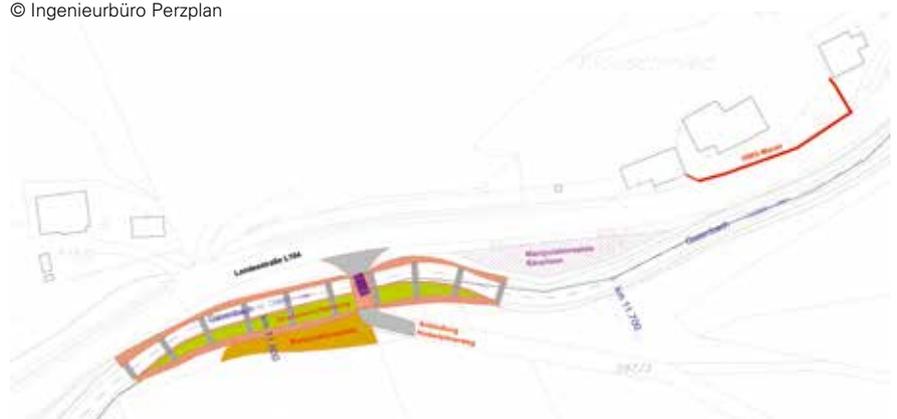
Planausschnitt BA03 © Ingenieurbüro Perzplan
